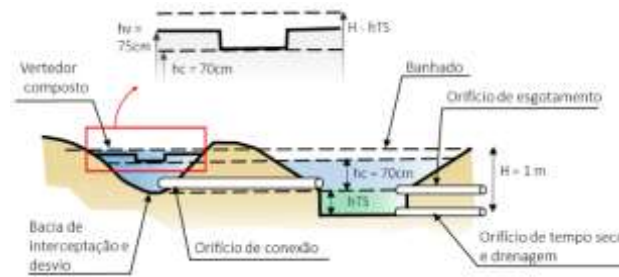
Vista em planta da configuração hidráulica proposta.
